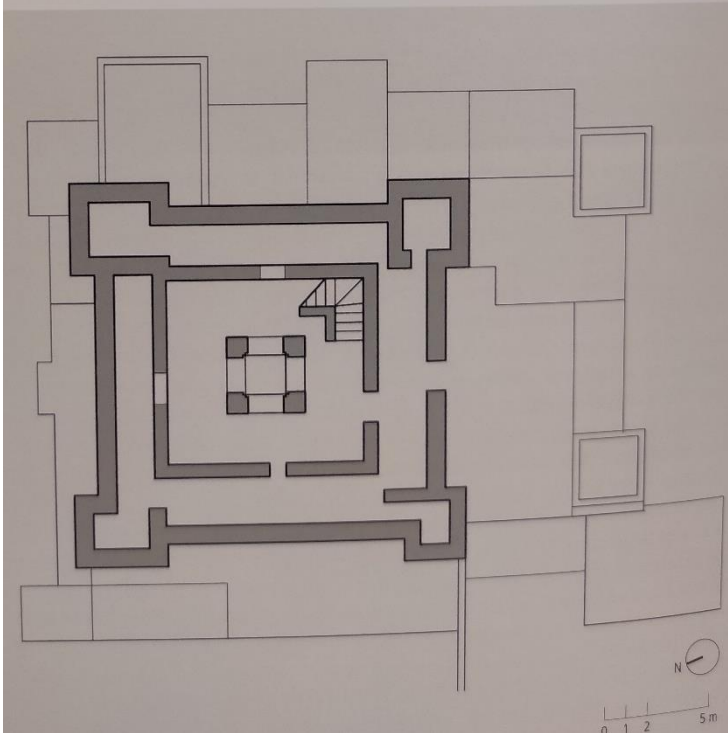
Planta y croquis de tighremt de Sidi Maati
